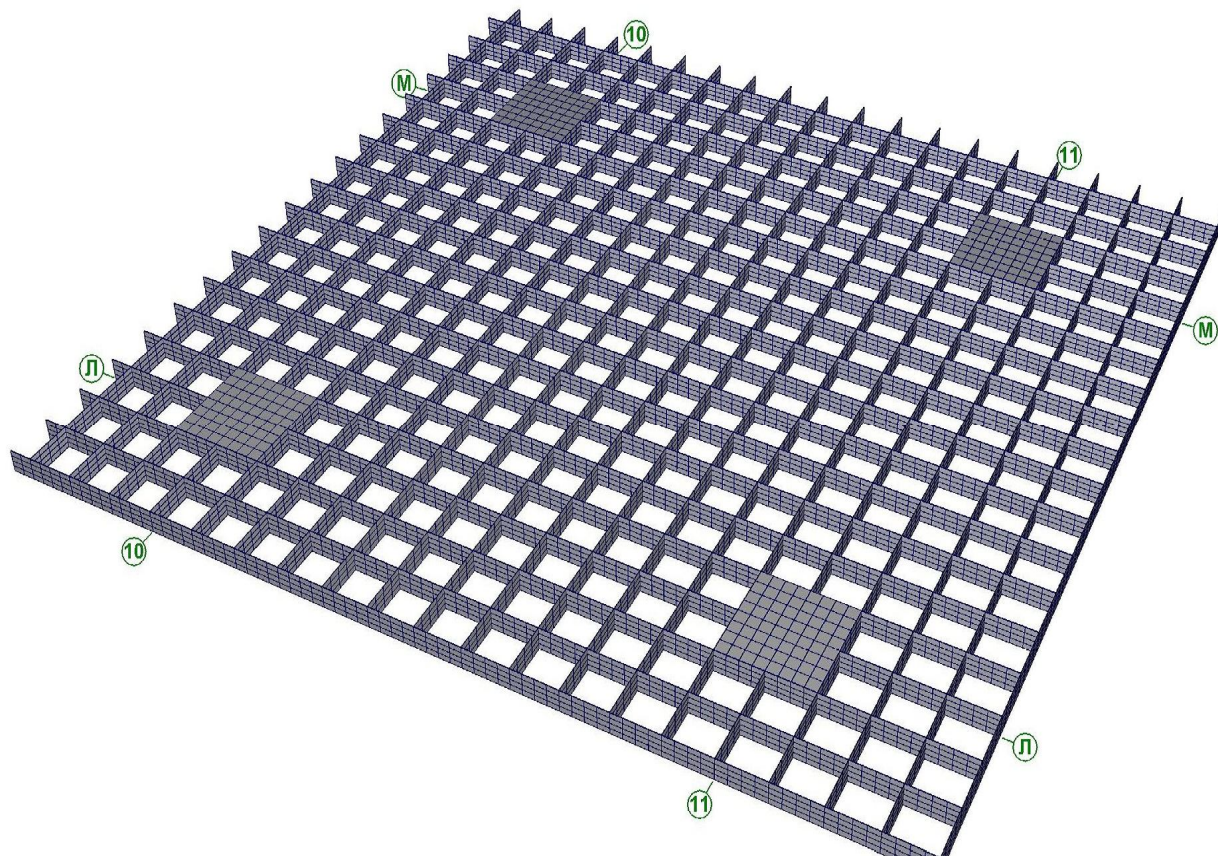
Фрагмент расчетной схемы кессонного перекрытия с монолитными участками замоделированными объемными элементами (полка условно не показана).
